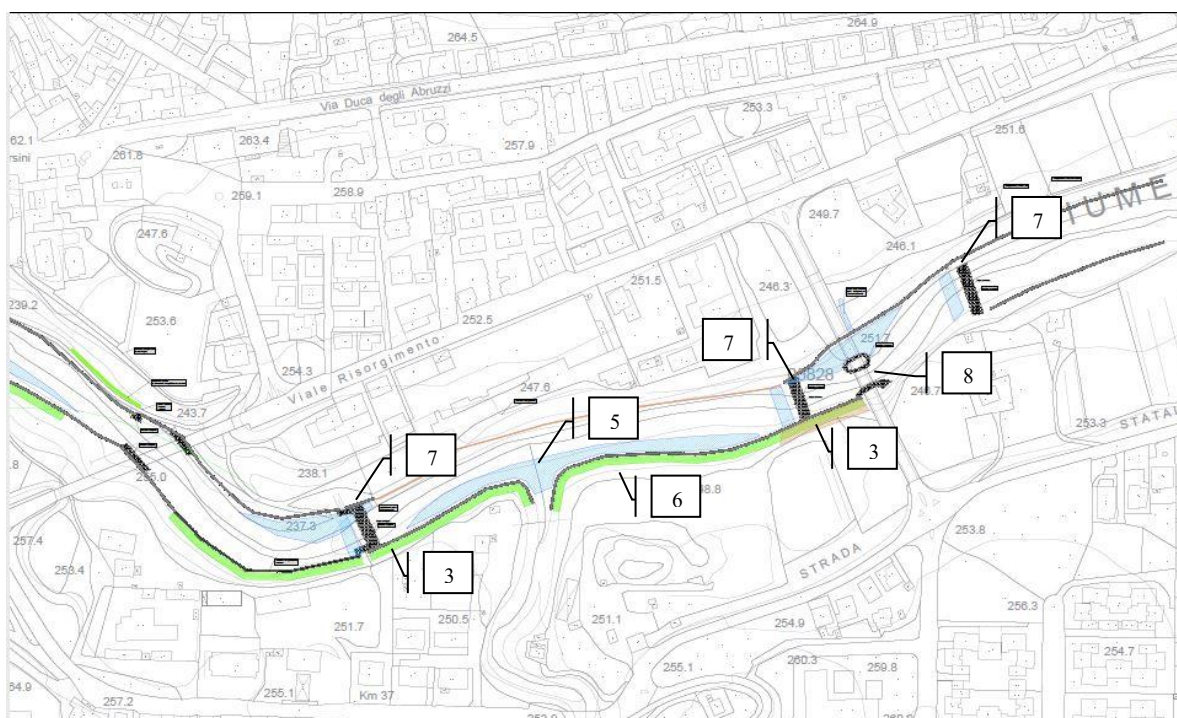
Planimetria di progetto con indicazione interventi (Tav A.13 progetto Definitivo/esecutivo)
